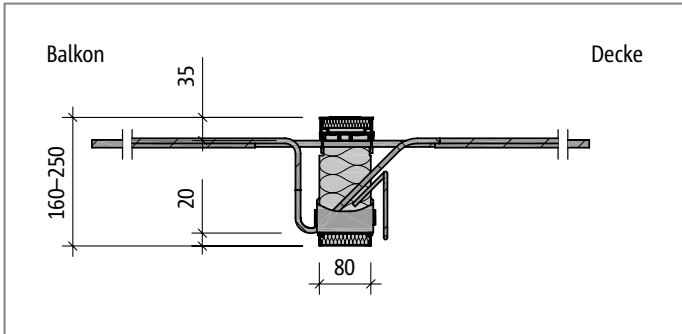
Schöck Isokorb® T Typ K-ID-M3
